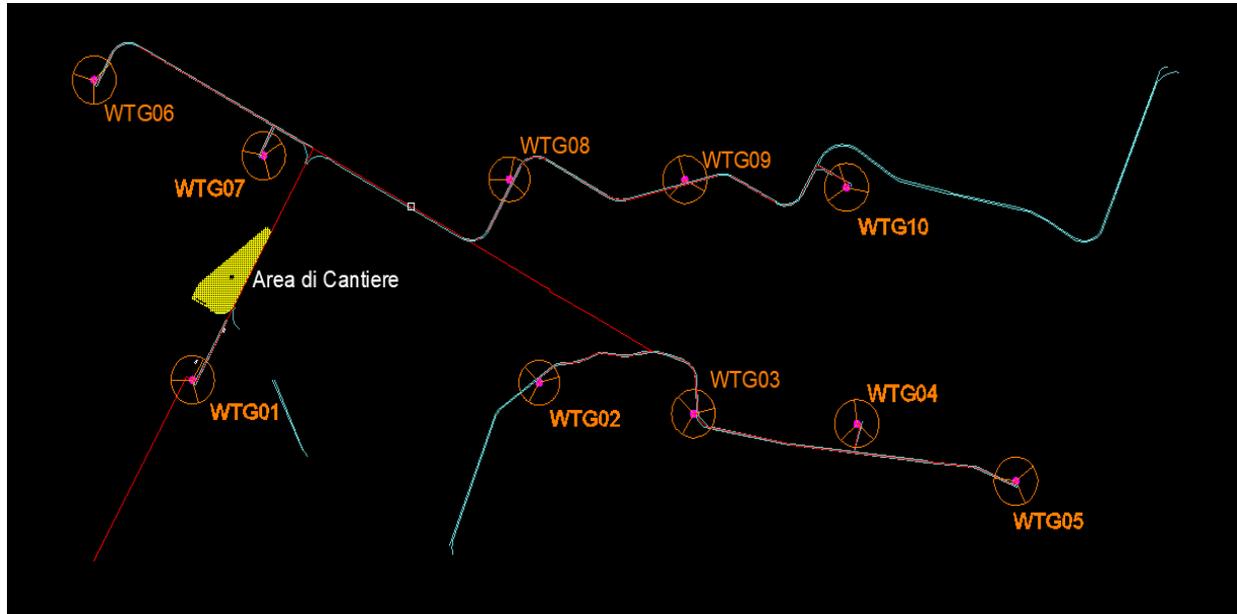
Schematizzazione dell'area di cantiere con dettaglio delle WTG di progetto, delle strade interne al cantiere e dell'area temporanea di stoccaggio e movimentazione.
